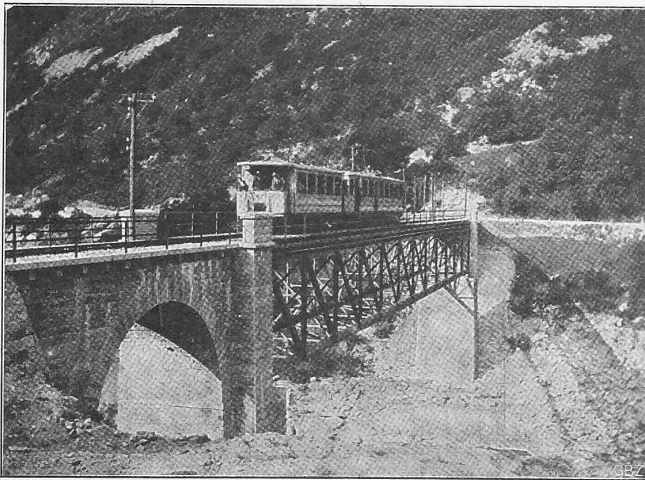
Fachwerkbrücke oberhalb Ponterolla.
